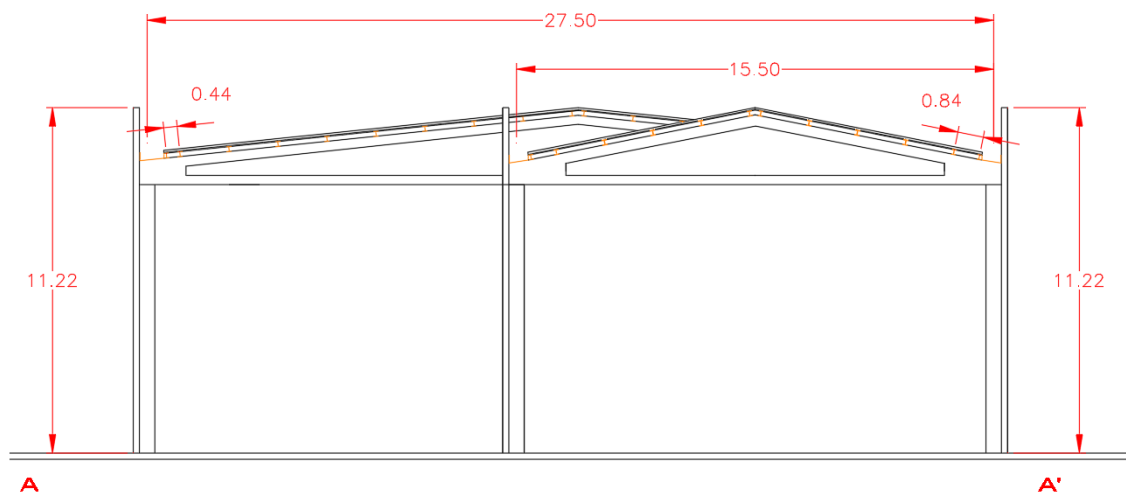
Vista Alçat Zona Magatzem (Cotes en Metres). Font: Elaboració Pròpia
